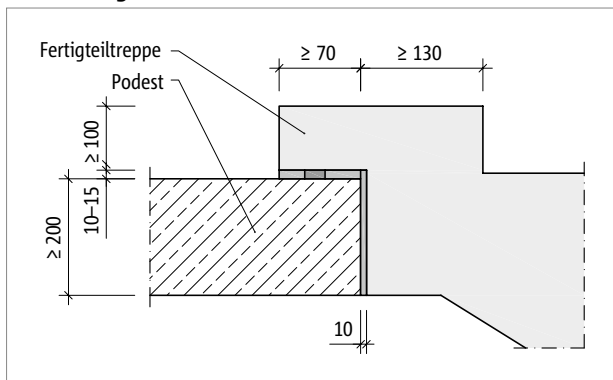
Schöck Tronsole® Typ BL: Ausführungsvariante Auflagerung eines Elementtreppenlaufs am Podestrand
